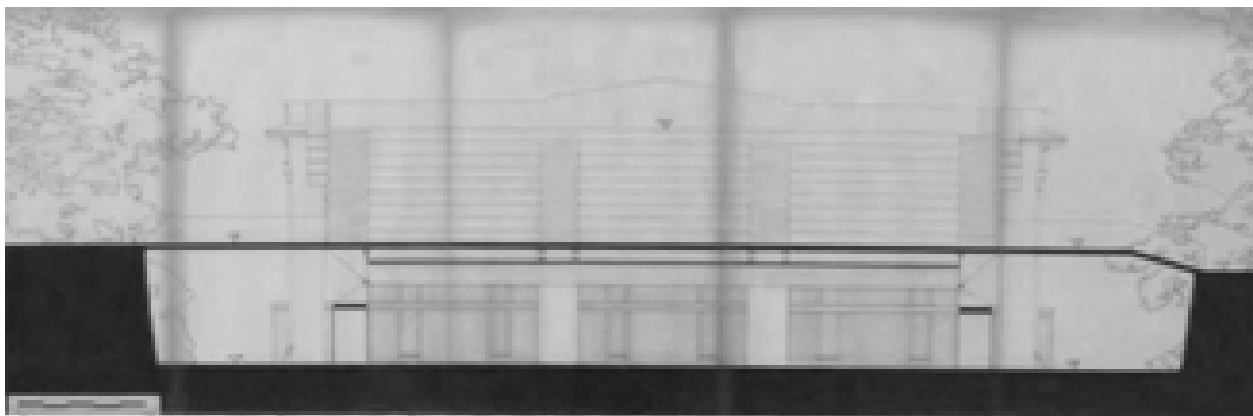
Sezione CC, stato futuro - Progetto del 15/07/1985, agg. del 15/01/1987 (AABS-153)
